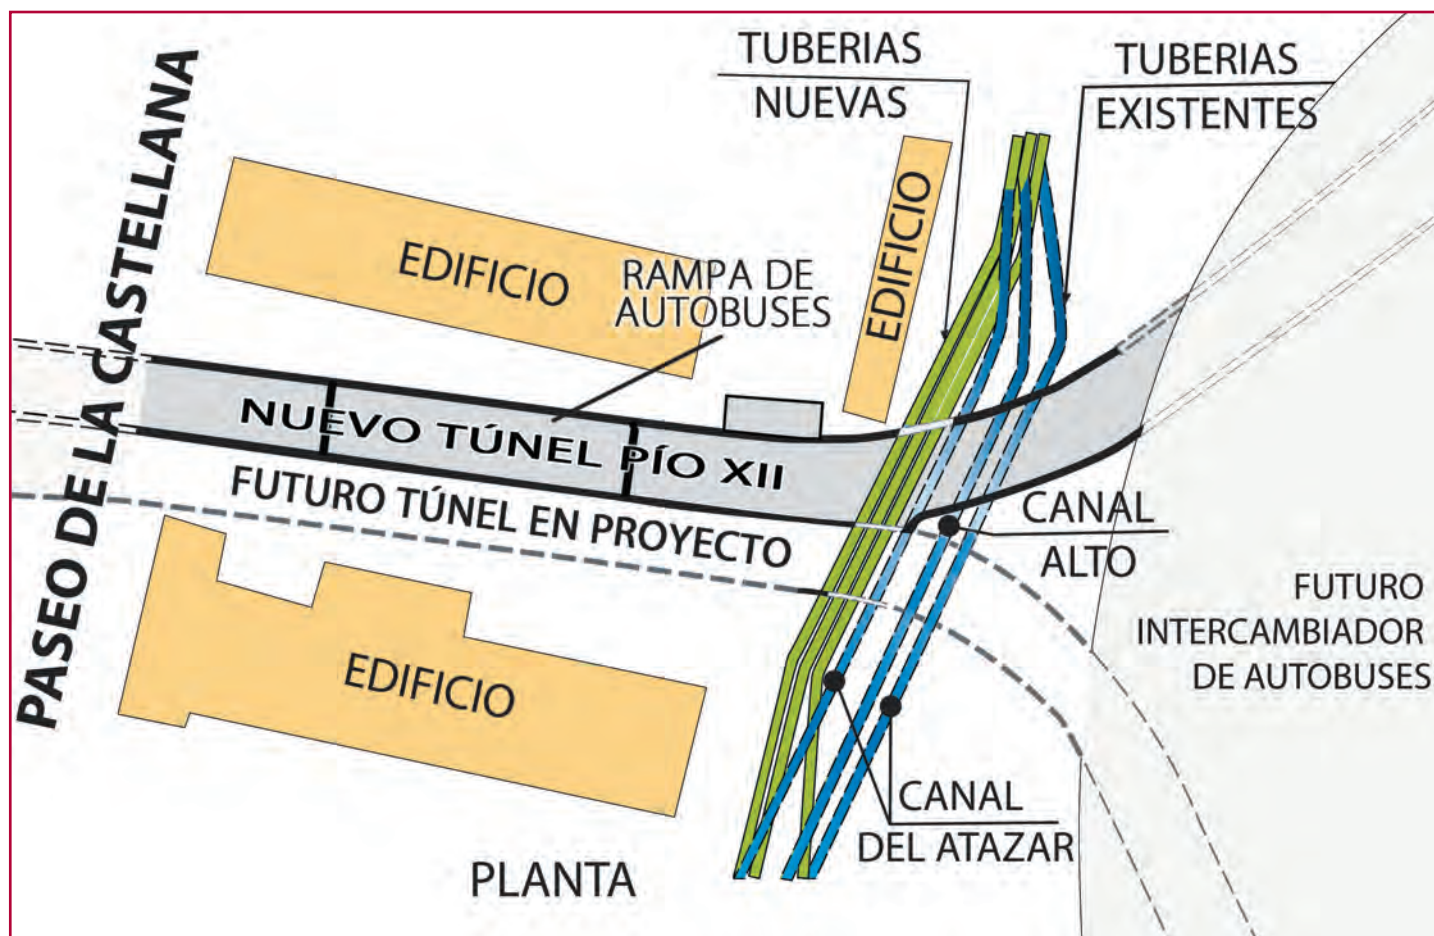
Planta. Trazado entre Castellana y futuro Intercambiador / Ground plan between the Paseo de la Castellana and the Railway Station.
